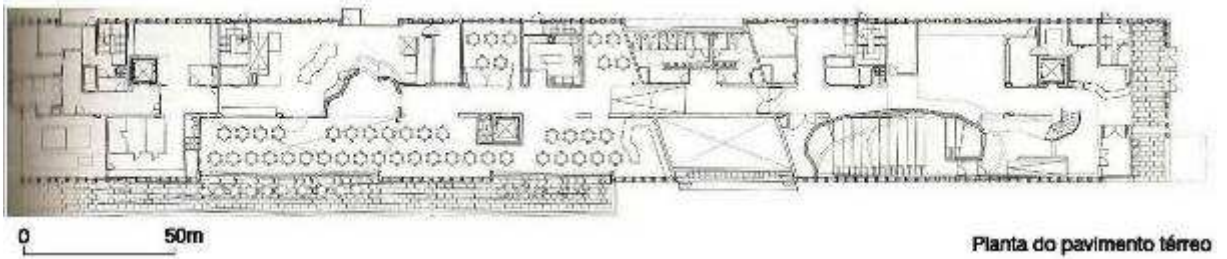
Planta do pavimento térreo, de uso essencialmente comum.
